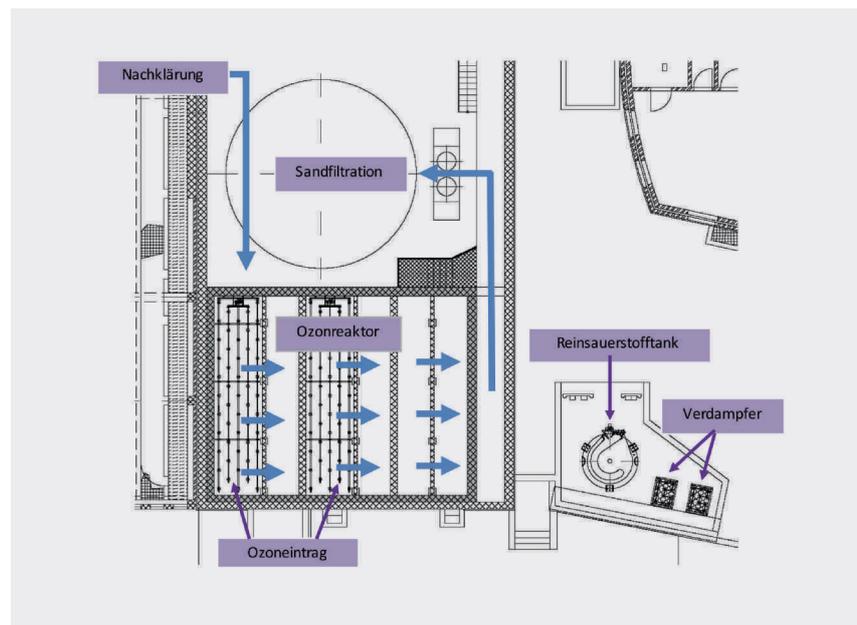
ARA Neugut: Grundriss der Ozonung zwischen Nachklärung und Sandfiltration
